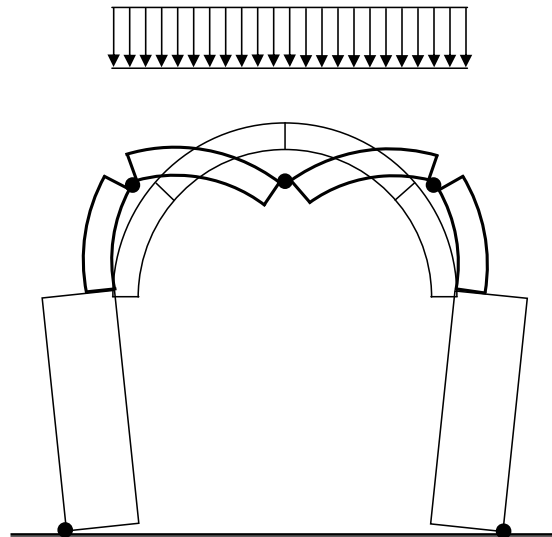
c. Meccanismo con apertura delle imposte: 3 cerniere nell'arco (alternate) e 2 cerniere nel piedritto (alla sua base); alternatively il piedritto può esibire un meccanismo traslazionale, anziché il ribaltante.
